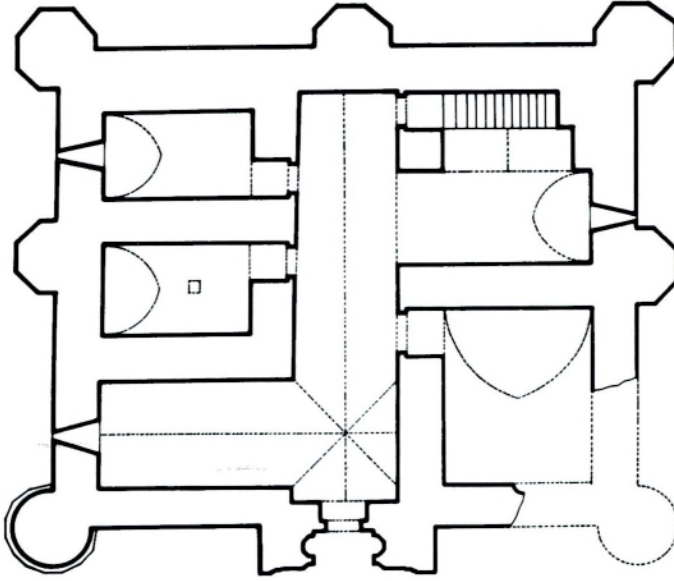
Sedre Kasrı, Zemin Kat Planı
